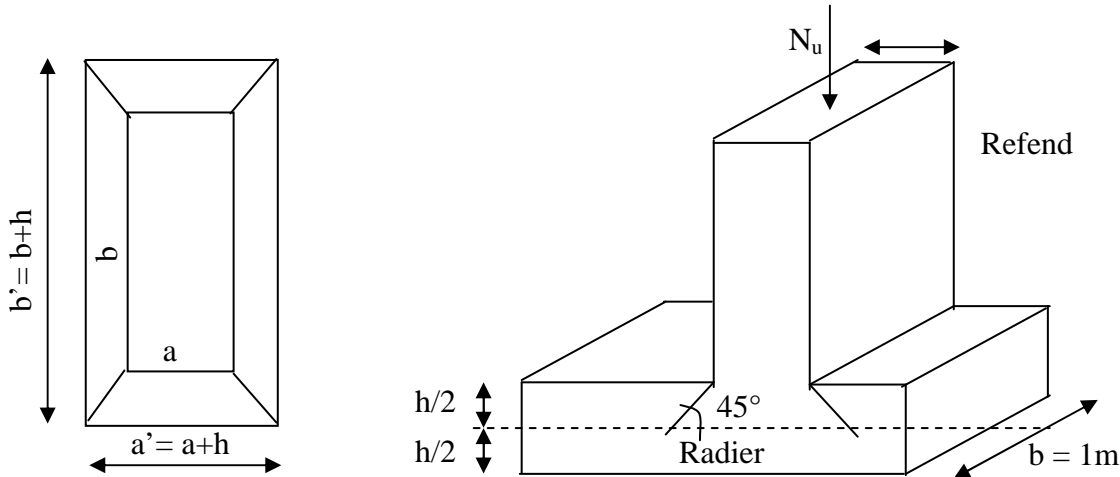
Périmètre utile des voiles et des poteaux.
